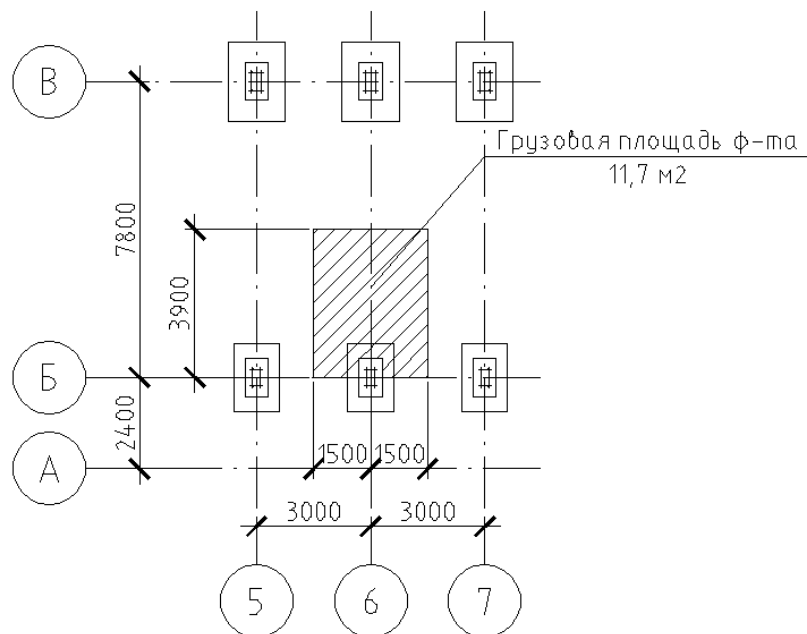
Грузовая площадь рассчитываемого фундамента
